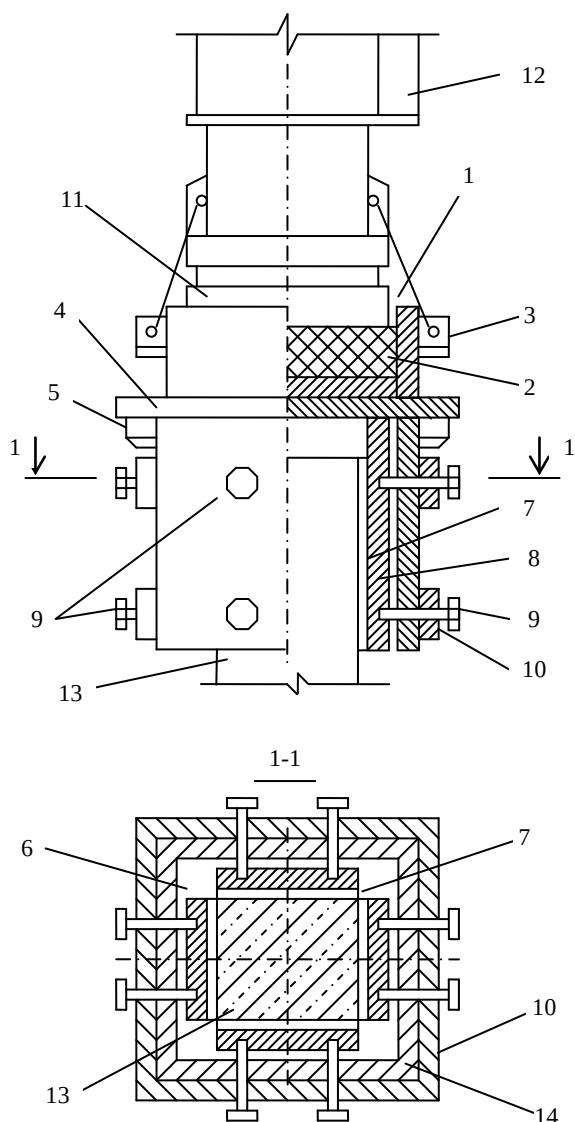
Схема свайного наголовника с боковой передачей усилий к свае
